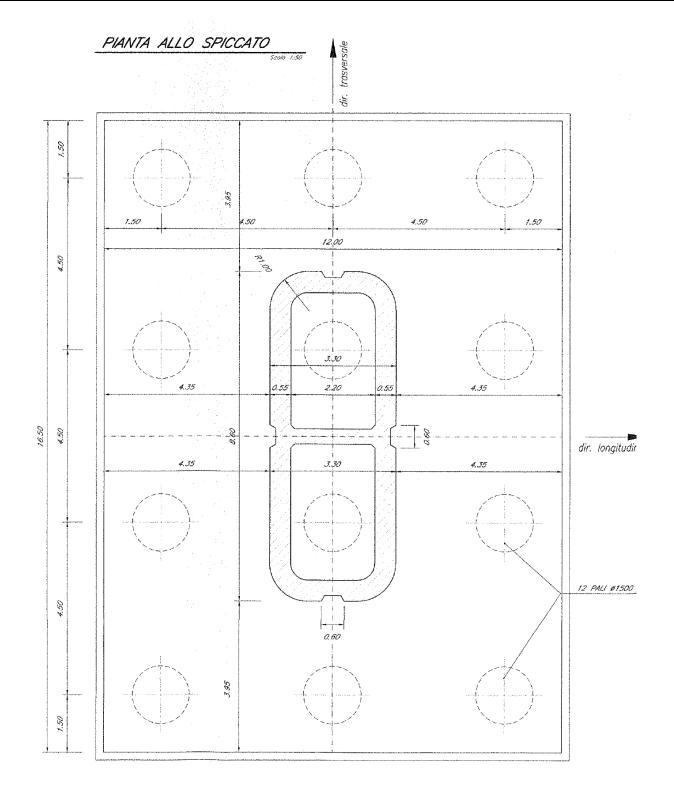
Plinto di fondazione e pali, vista in pianta - Sezione del fusto pila [m]
